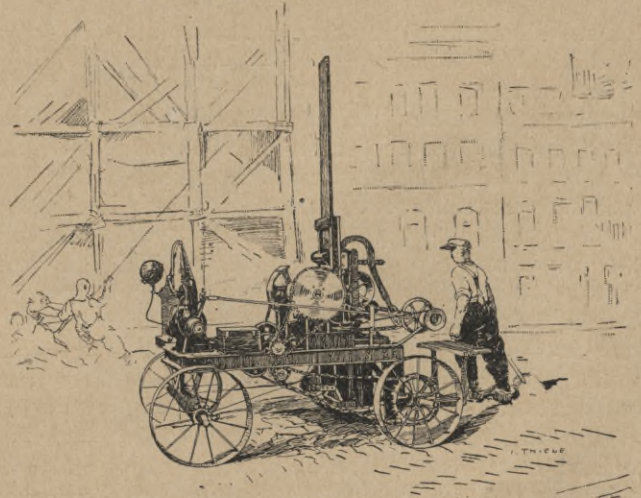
Selbsttätige Stampfmaschine zum Wiedererfüllen von Kabelgräben u. dgl.
